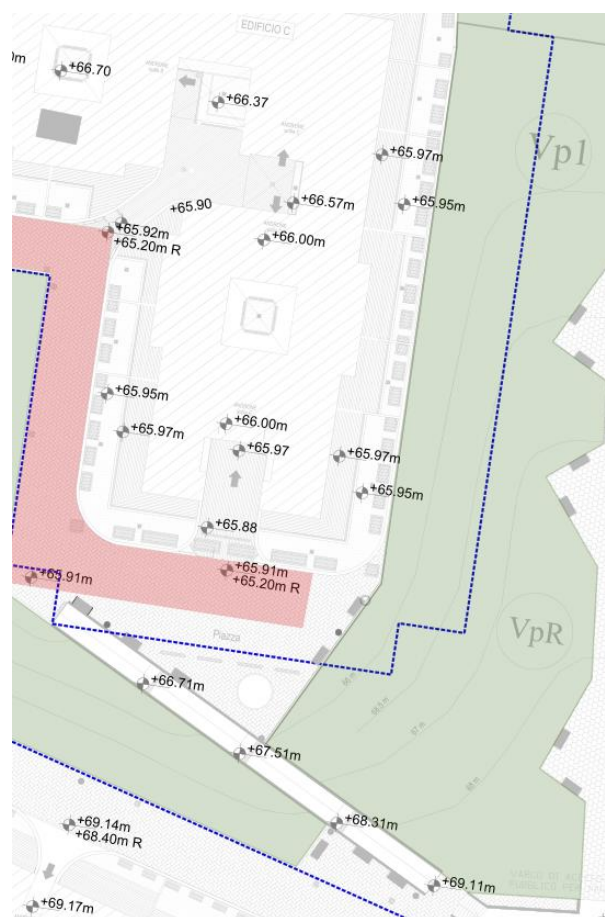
Zona con pavimentazione e opere di captazione acqua meteorica
